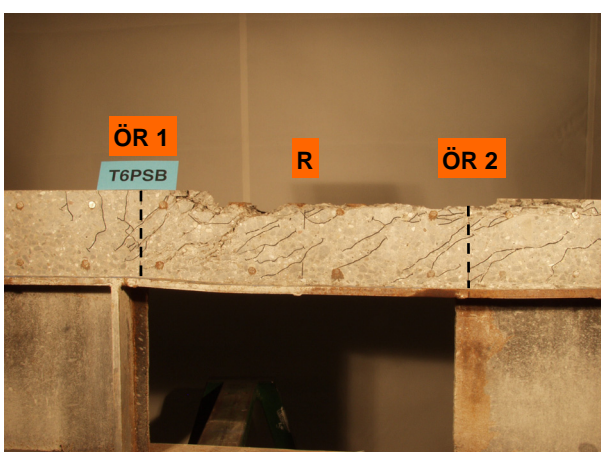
Rissbild auf der rechten Betongurtseite
